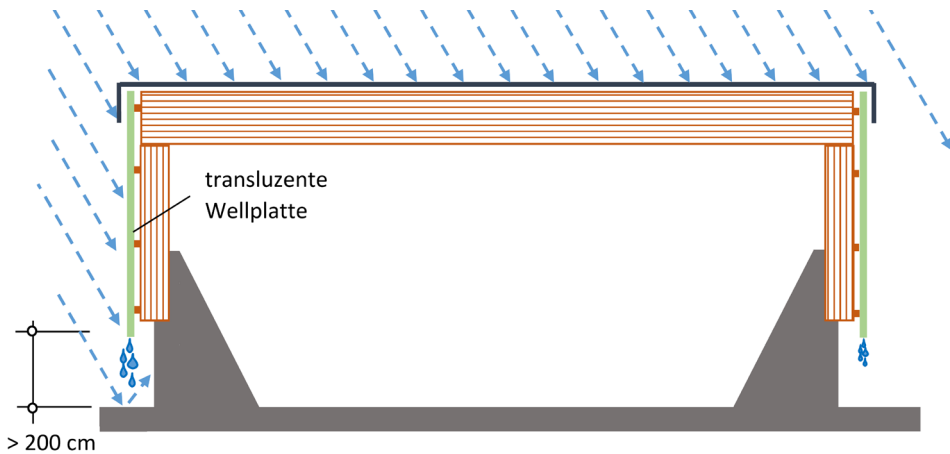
Prinzip für den Hallenquerschnitt einer Salzlagerhalle o. ä.
